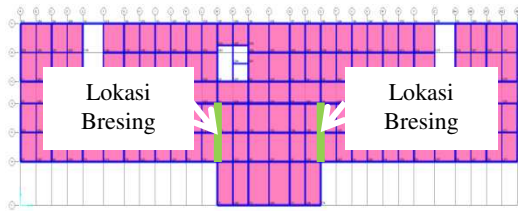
Struktur Alternatif dengan V- Brace (Tipe D)
